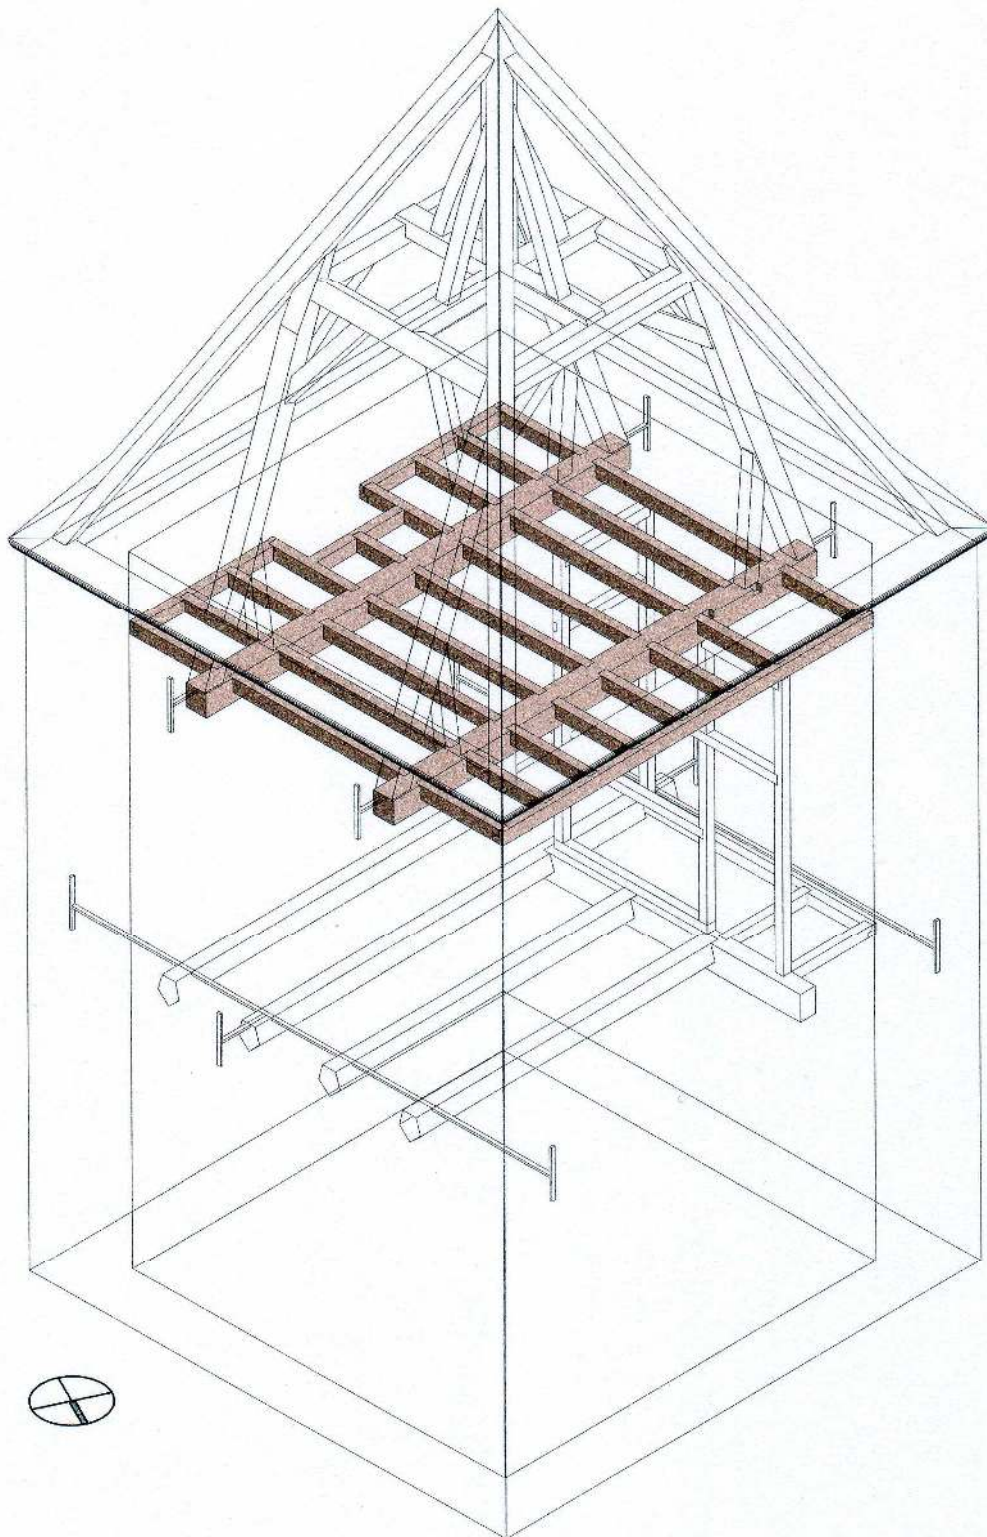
Vue en perspective. Plancher à solives et poutres. Hors échelle. IG 2008.
